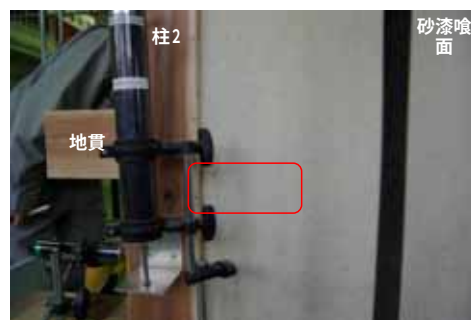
砂漆喰側 1/100rad 地貫のこじり効果によるひび割れ
